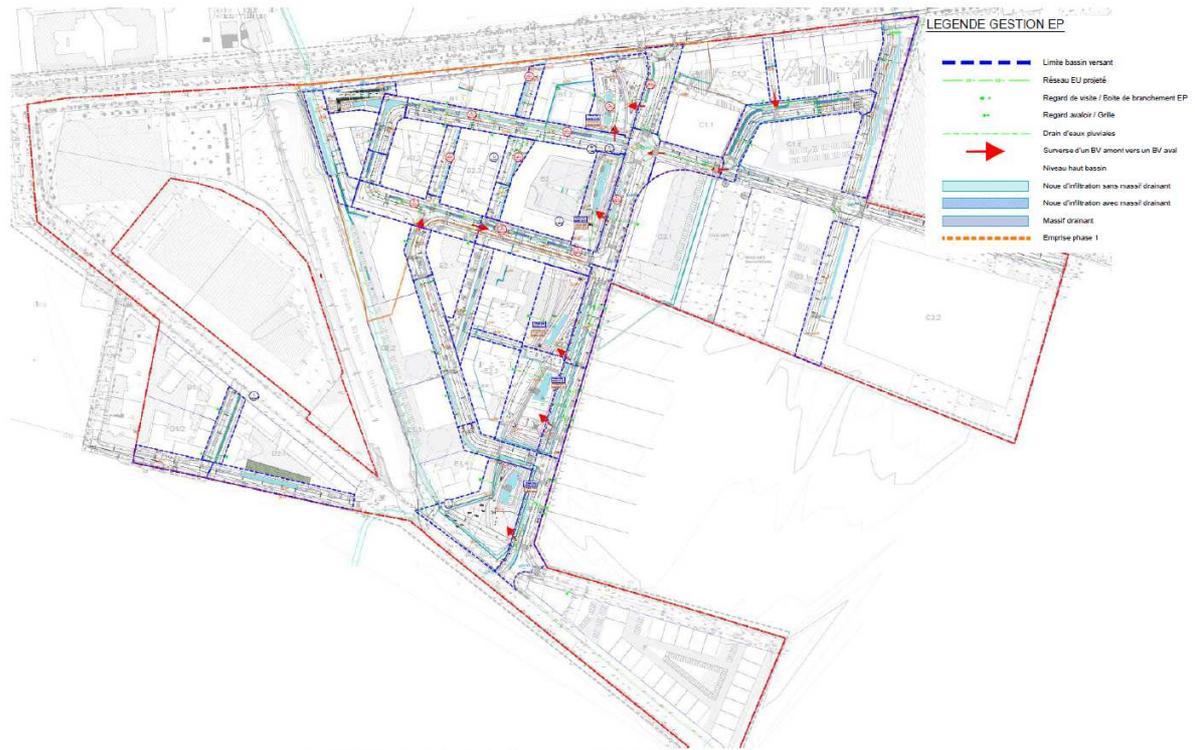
Plan de gestion des Eaux pluviales - Bassin versant (AVP - 09/2021)
